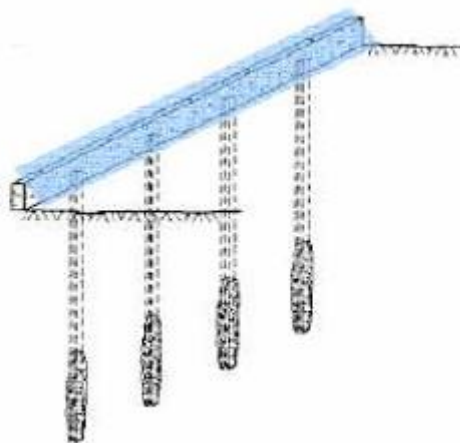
Esquema de uma viga de coroamento e sua ligação aos perfis metálicos
